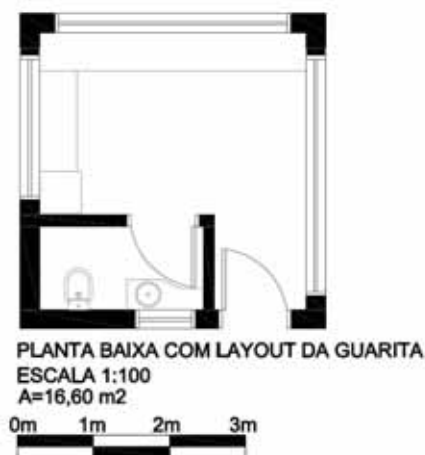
Planta baixa da guarita. Fonte: FERRO, 2011.
